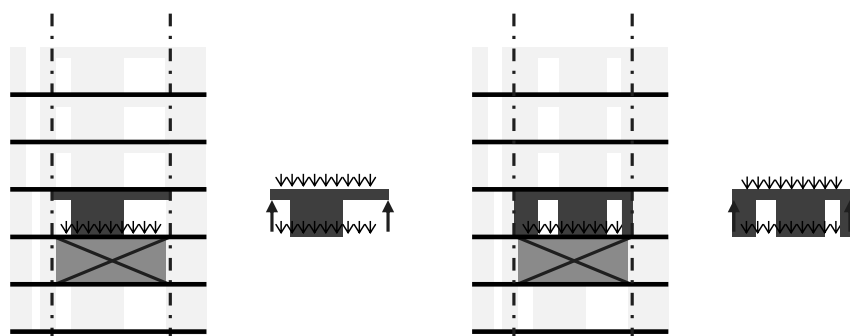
Parete interrotta funzione strutturale della trave parete risultante al piano superiore, indebolita dalle aperture
